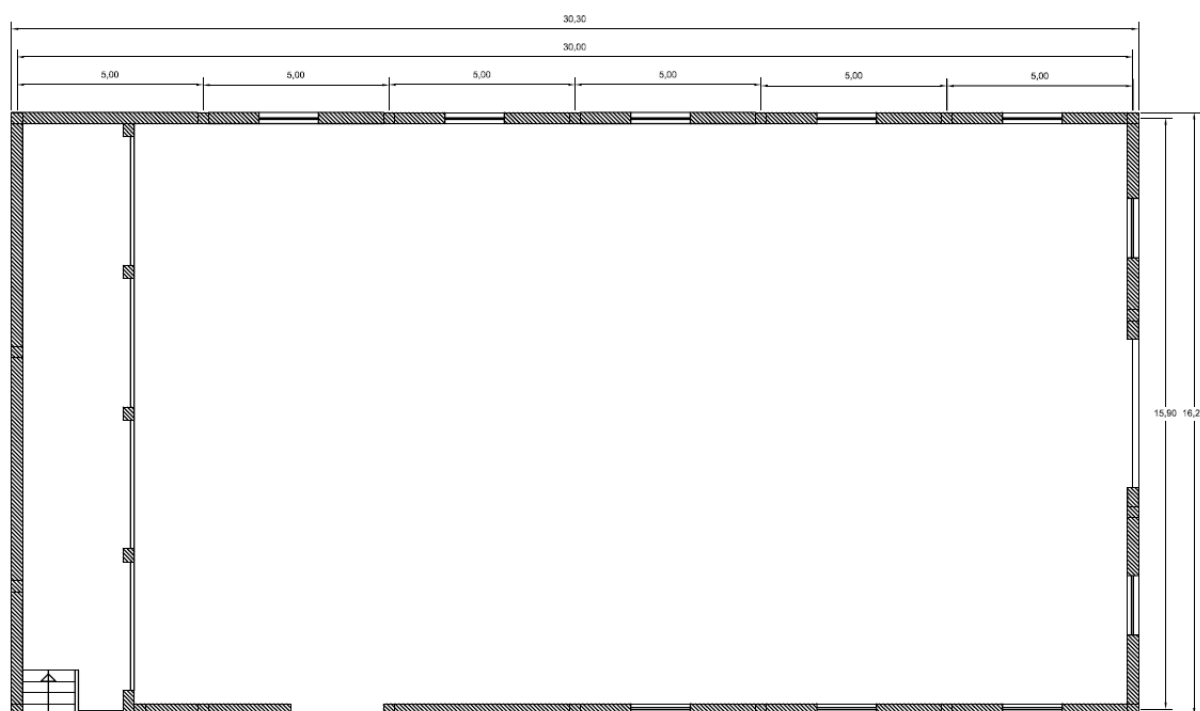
Planta do picadeiro – cortesia GEPEC.
